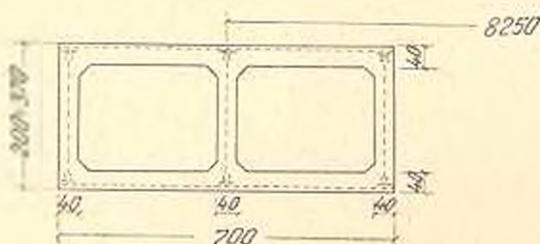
Сечение арки. Пунктиром показана жесткая арматура.
